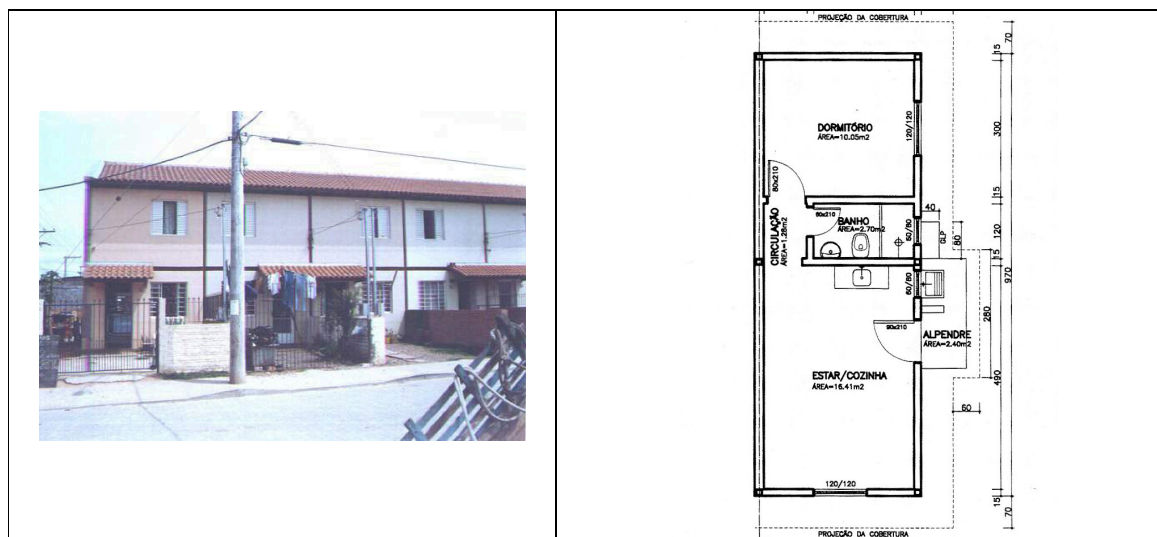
Sistema Construtivo A – térrea e 2 pavimentos (Fonte: adaptado de SPERB, 2000)
